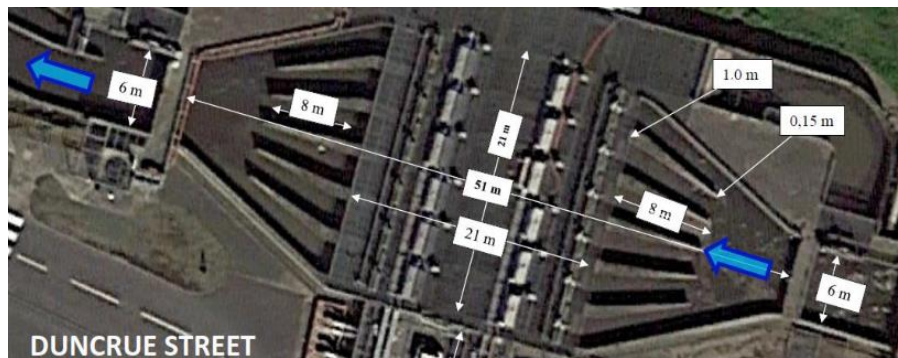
Vista en planta de la estructura, Duncrue St. Inlet, medidas con Google Earth
